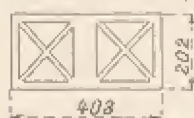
Poussées unitaires sur les rectangles parallèles.
